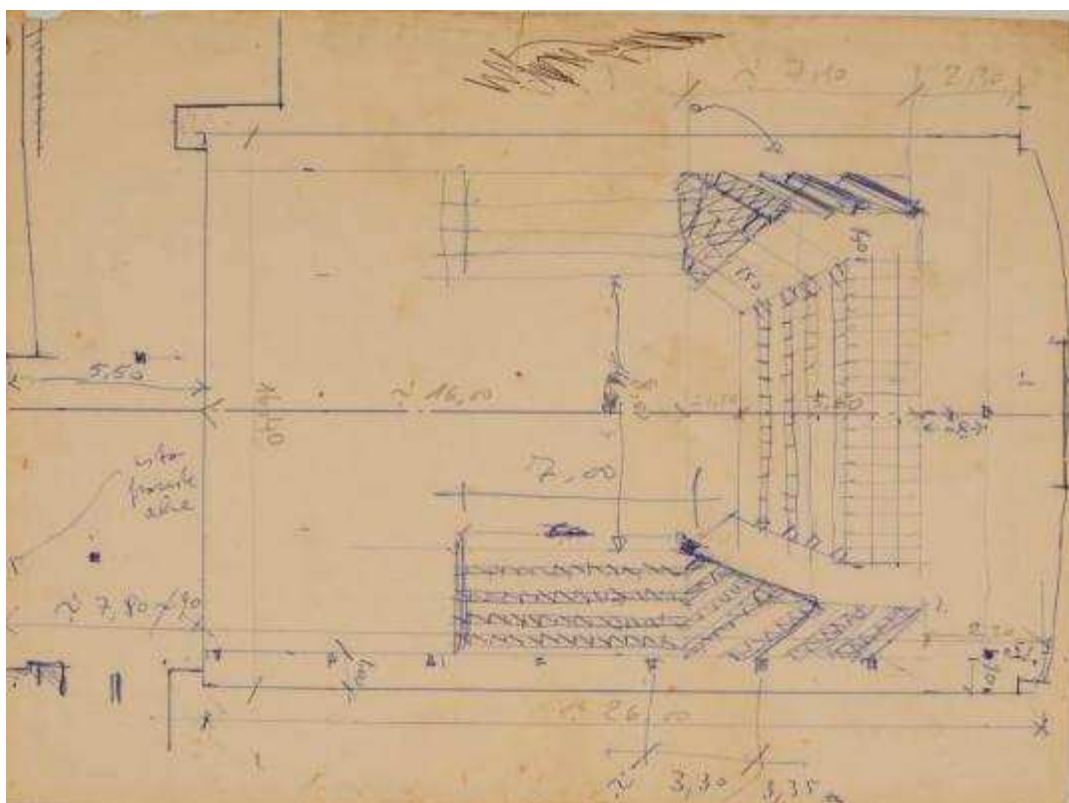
Planta esquemática da proposta de palco e plateia para o teatro Tereza Rachel. Lina Bo Bardi, 1971/72.
